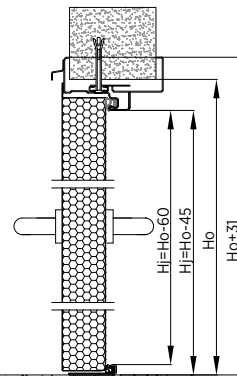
Pose au mur - porte à un vantail - bâti enveloppant à rupture de pont thermique - coupe verticale
